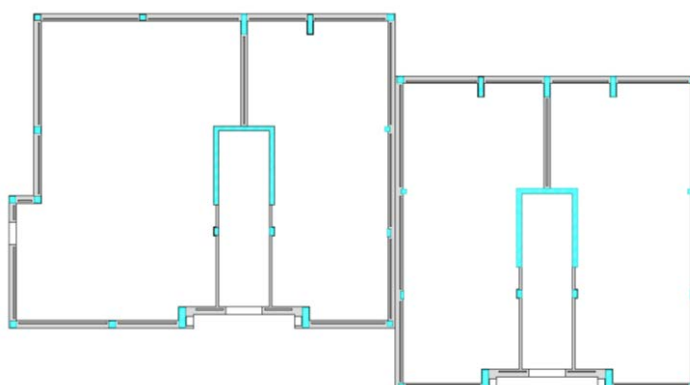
Planta tipo T4-T2 e T2-T2 (R/C)
